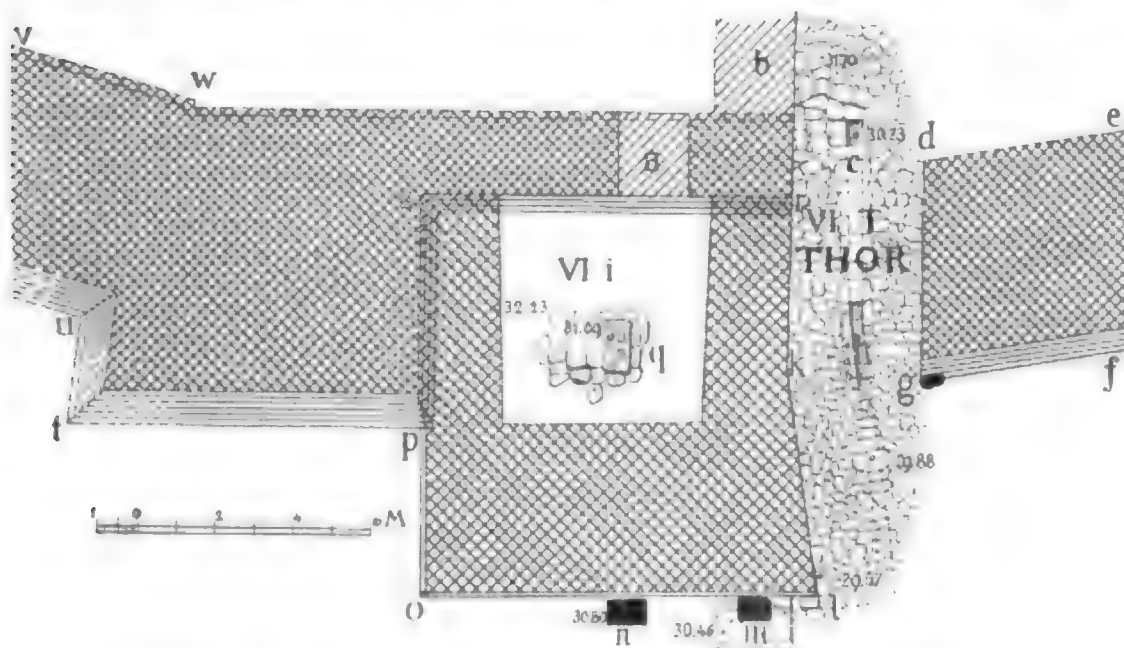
Grundriss des Süd-Thores VI T, jetziger Zustand.
